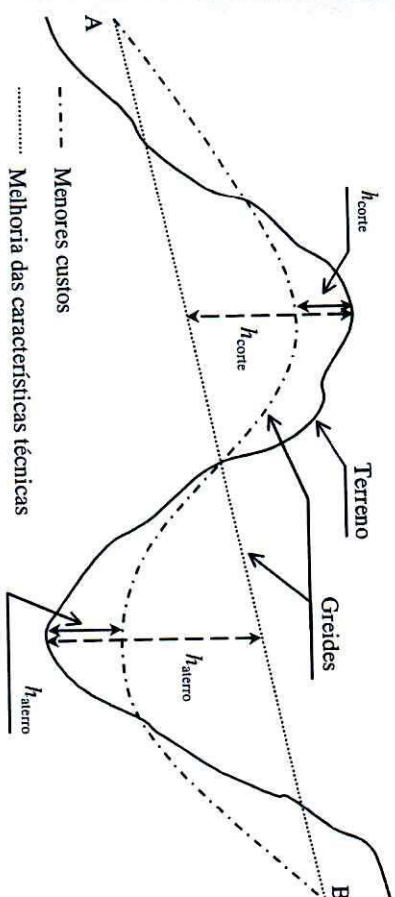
Perfil Longitudinal (Fonte: PEIXOTO).
